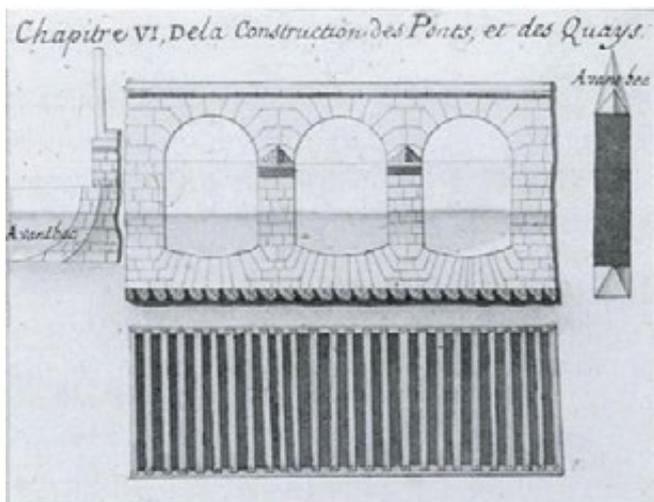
Fondation sur radier général (extrait du traité d'architecture de Philippe de La Hire)
